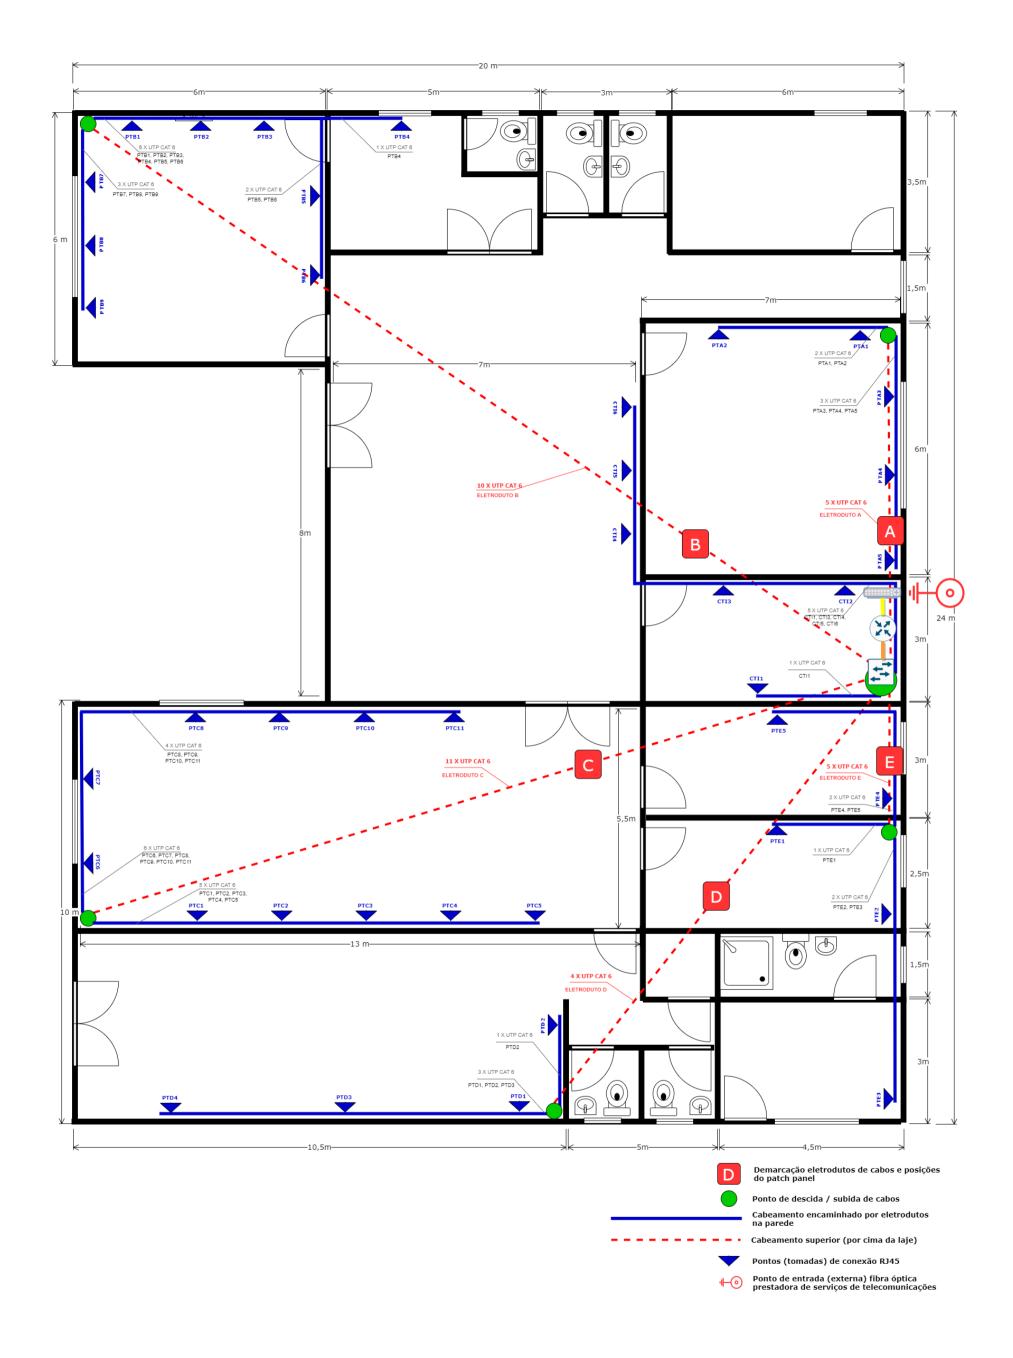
Planta Lógica do Edifício da Empresa APS Engenharia.
